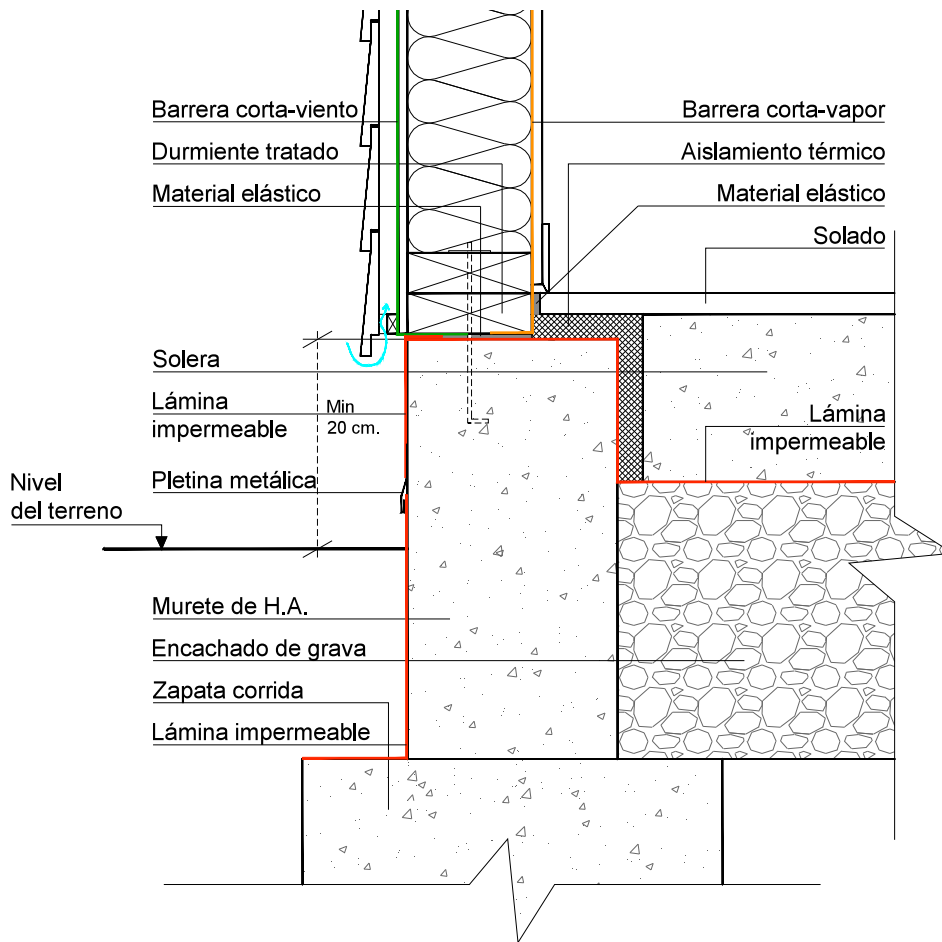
Encuentro entre el muro de fachada y la cimentación.
